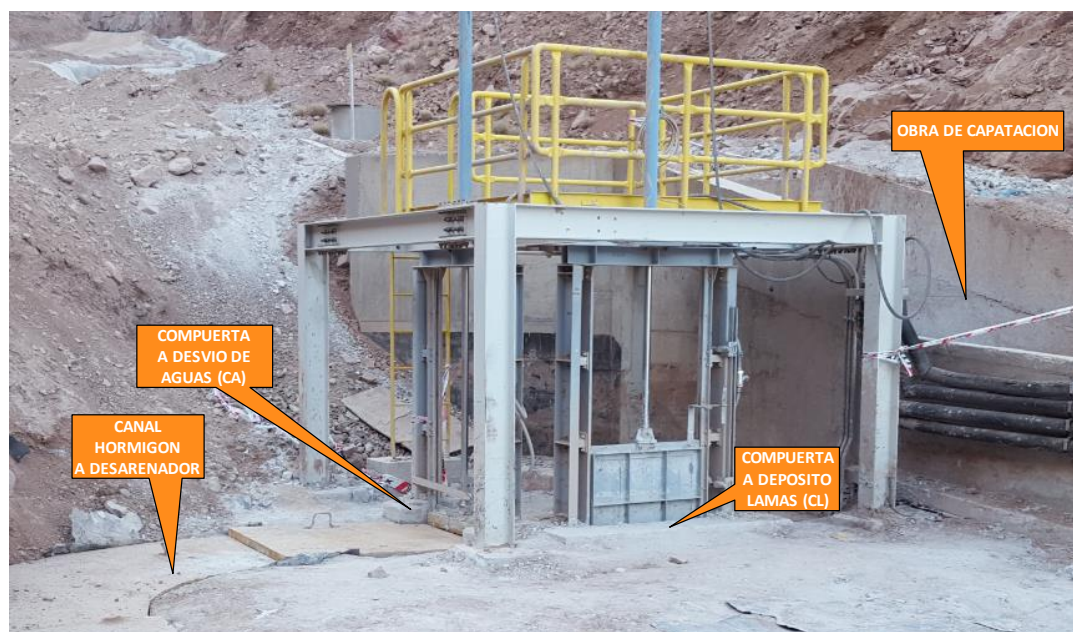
Planta obra de captación de aguas – IP-A2.
